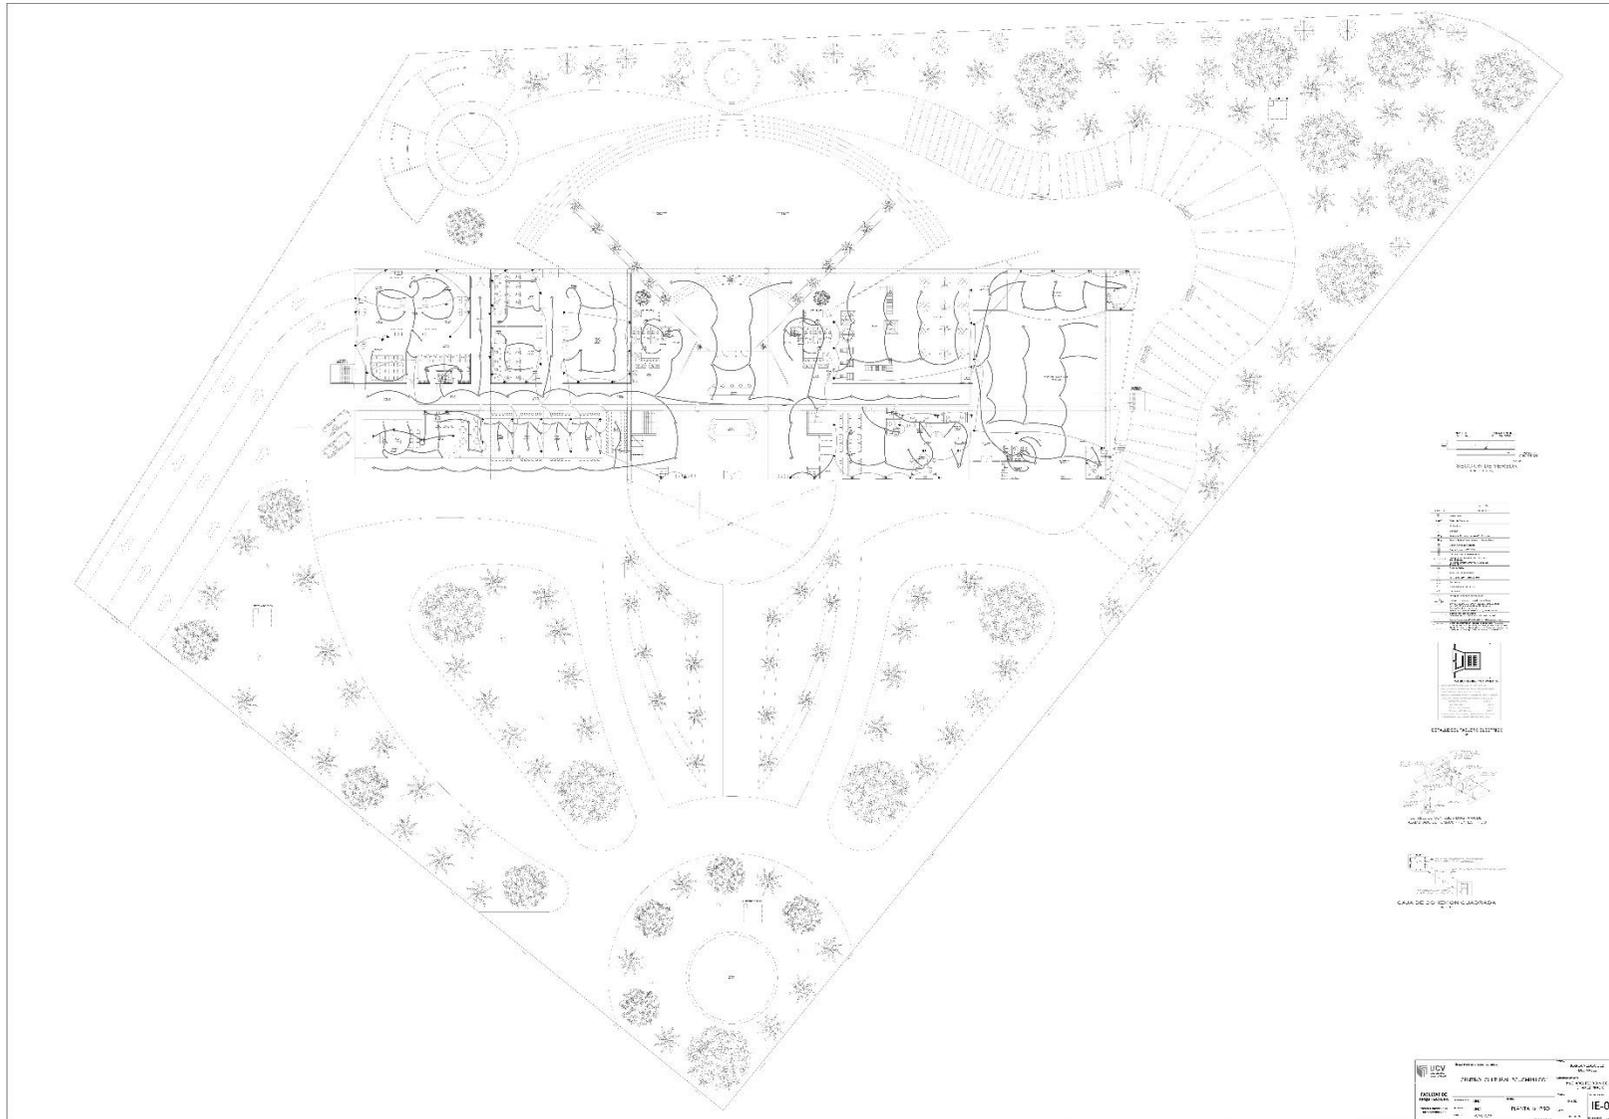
Plano Eléctrico Planta 1er Piso. Elaboración propia
